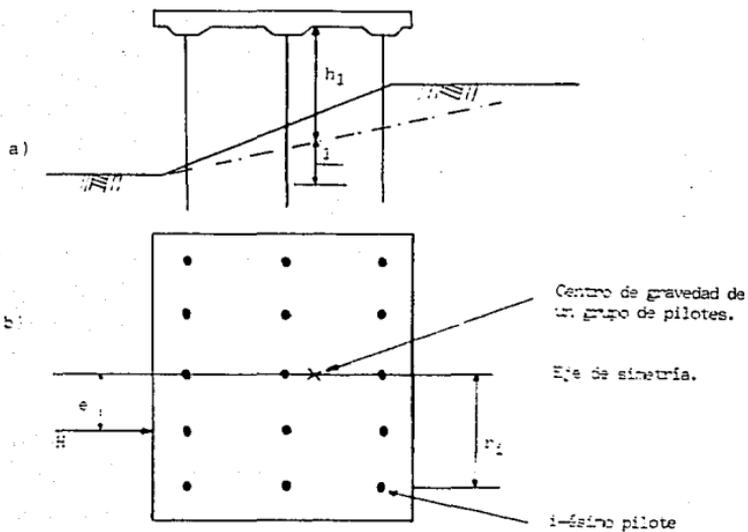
Colocación de pilotes y punto de aplicación de la fuerza horizontal
